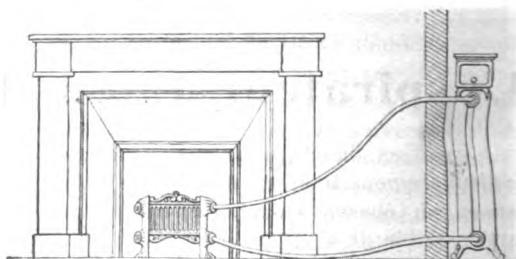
CHAUFFAGE DE DEUX PIÈCES
